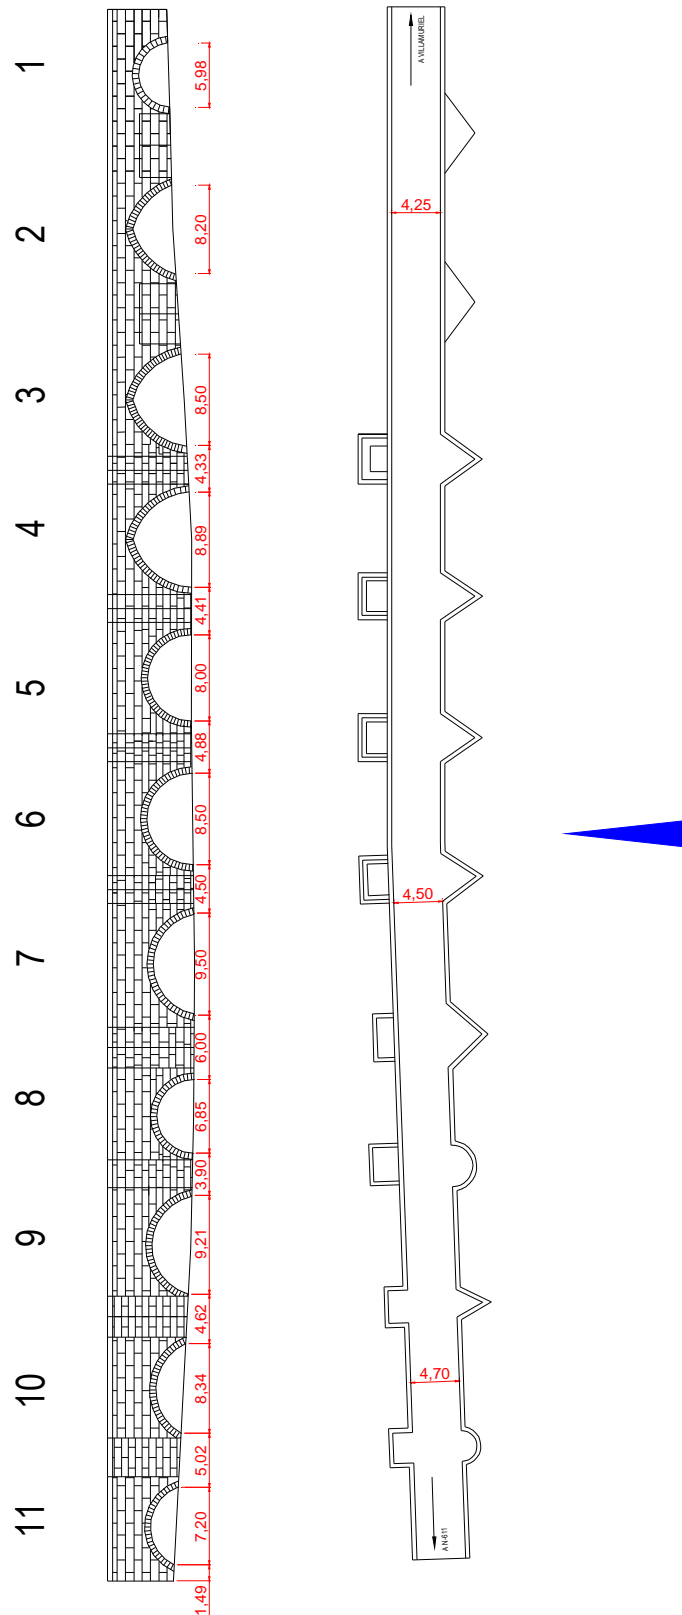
Planta y alzado de aguas arriba del puente en Villamuriel de Cerrato
